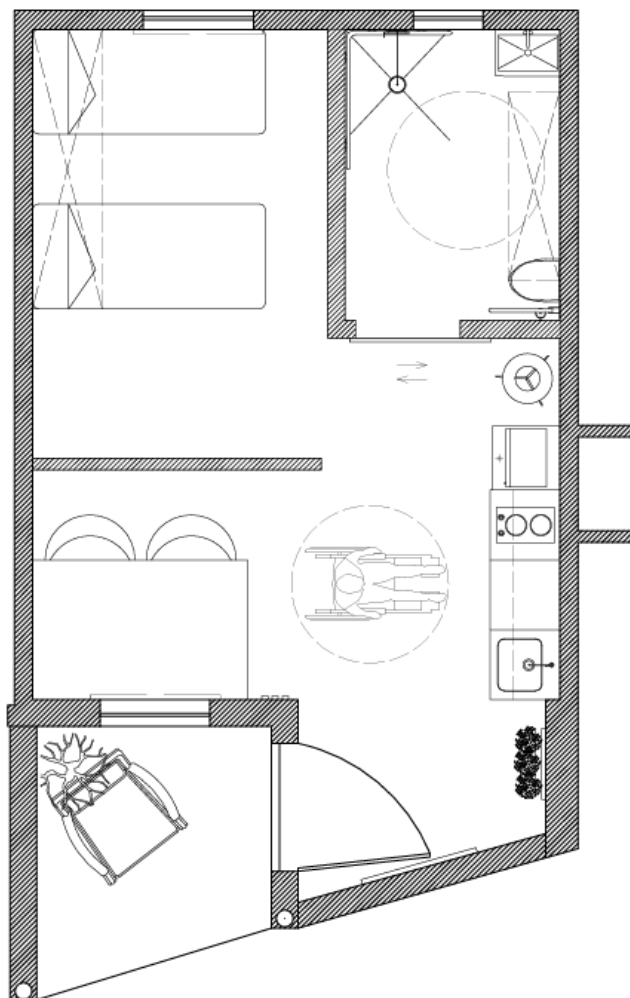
Planta final - *Bungalow 1* (Fonte: autora)
